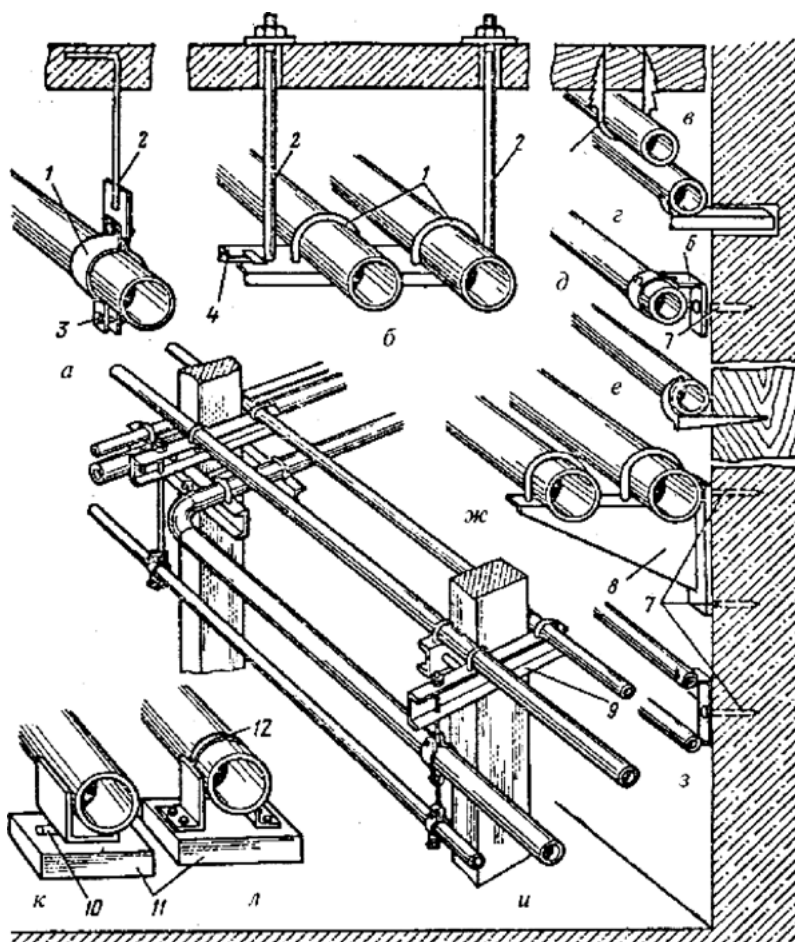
Способы крепления труб: а — с помощью подвесок; б — то же, но с балкой опоры; в — с помощью различных скоб; г — с помощью кронштейнов; д — хомутами; е — крючьями; ж — с помощью подкосов и кронштейнов; з — приваренными скобами; и — крепление к столбам; к — крепеж на скользящей опоре; л — крепеж на неподвижной опоре; м, б — крепеж в виде хомутов; 2 — стержень; 3 — гайка с болтом; 4 — балка; 5 — скоба; 7 — дюбель; 8 — подкос; 9 — прокатная сталь (швеллер); 10 — цилиндр; 11 — опора; 12 — сварной узел
